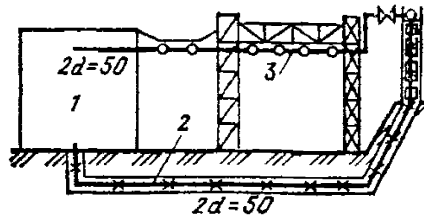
Подземная и надземная прокладка трубопроводов:
